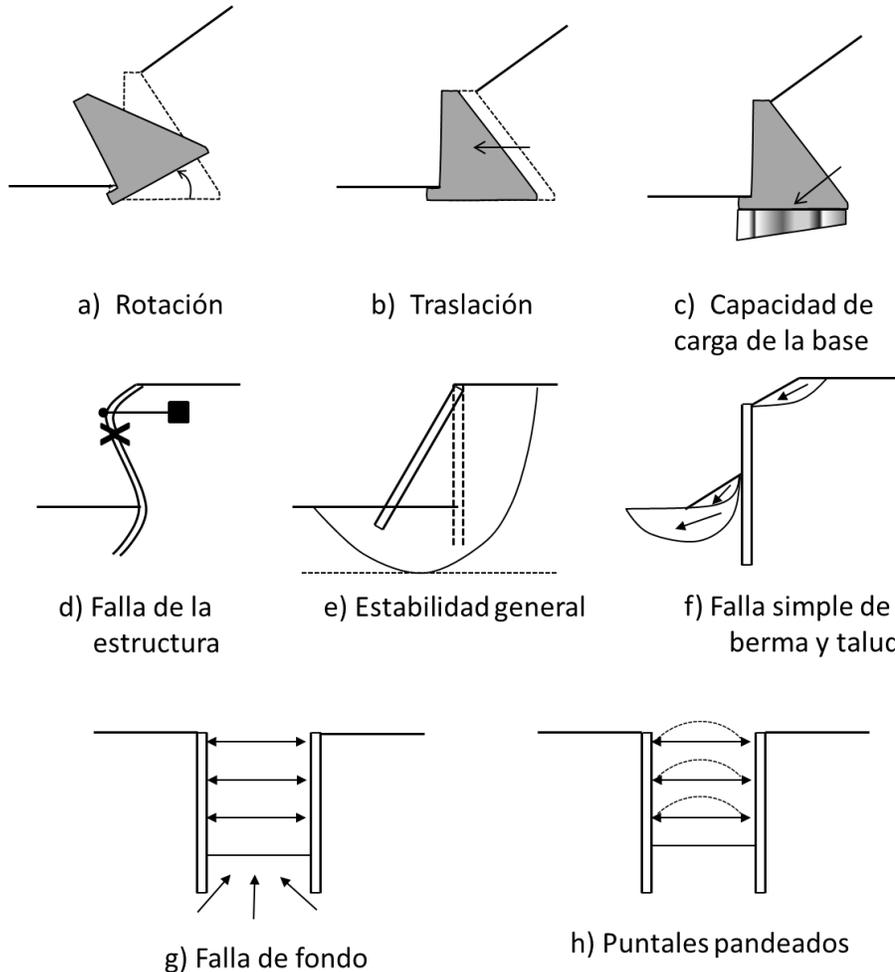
Mecanismos probables de falla en excavaciones ademadas
